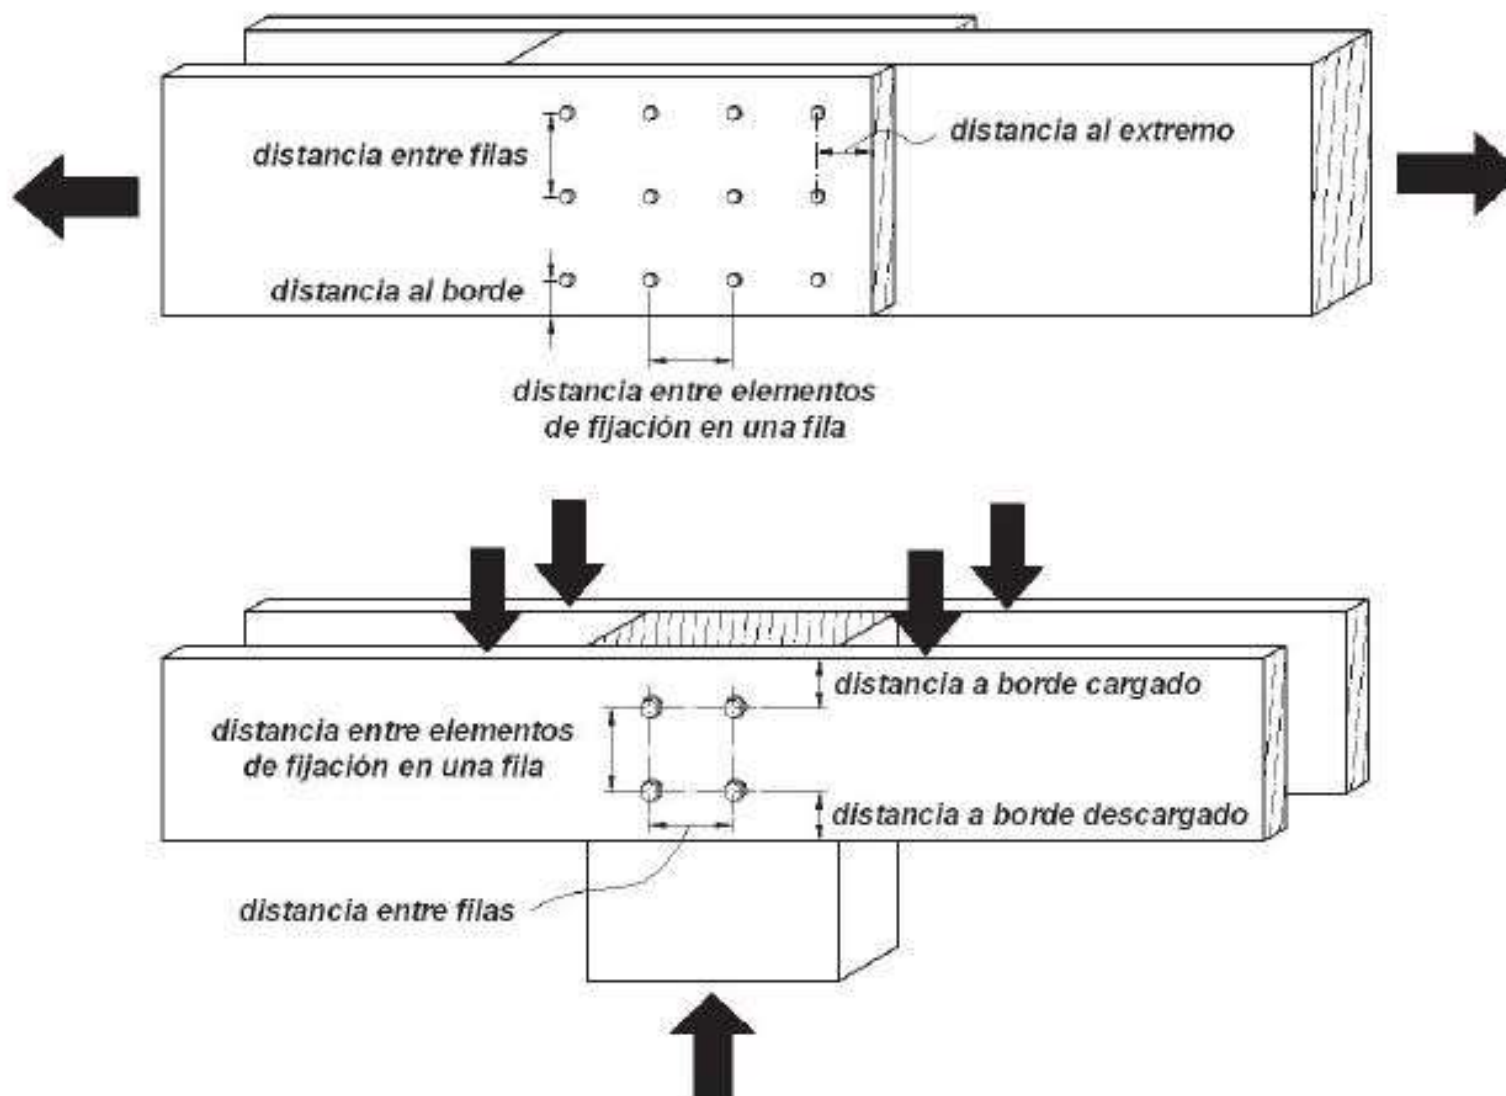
Geometría de las uniones con elementos de fijación de tipo clavija.
